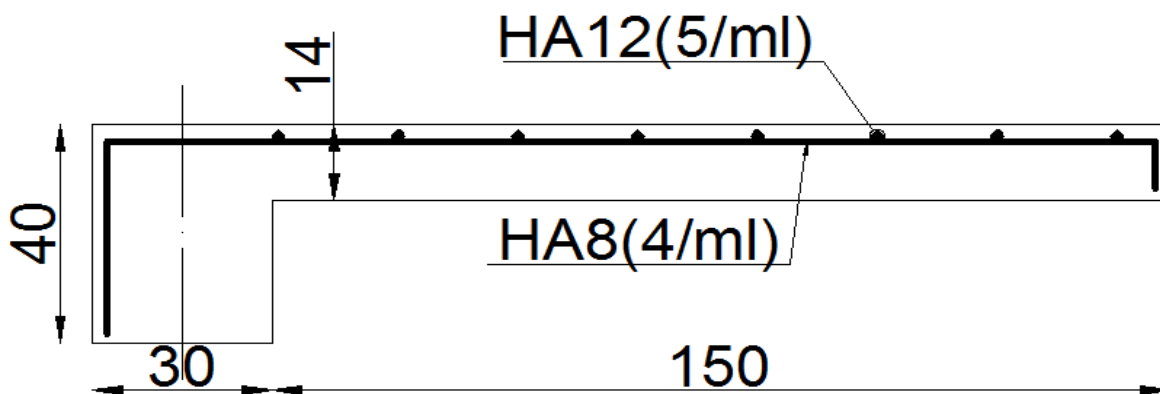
schéma de ferraillage de la dalle pleine sur 3 appuis
